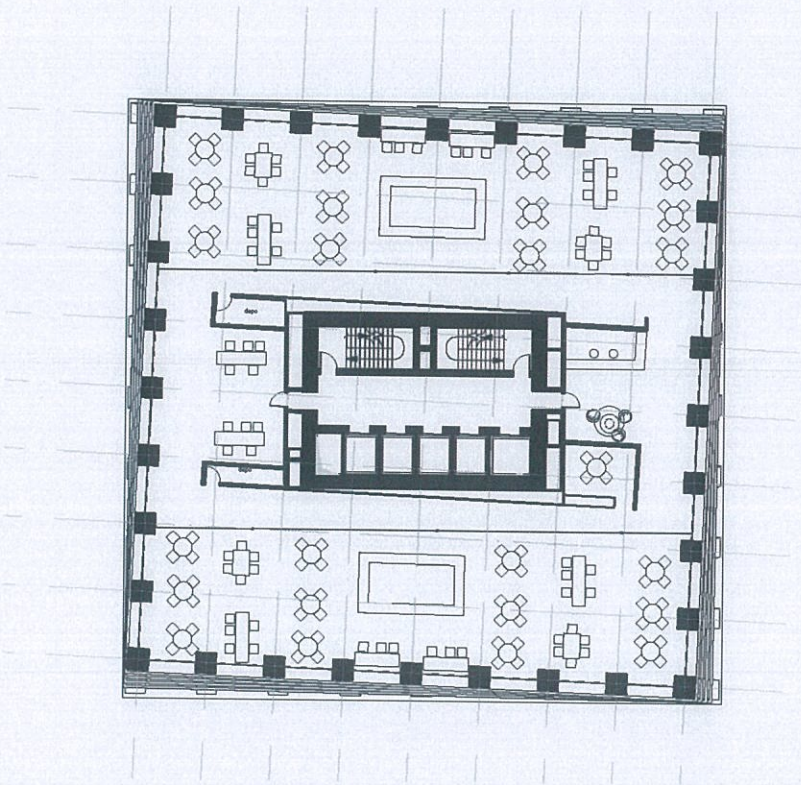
Planimetri e katit +4, në kuotën +22.68 (Skema e funksionit tregtar, kati 0-4)
